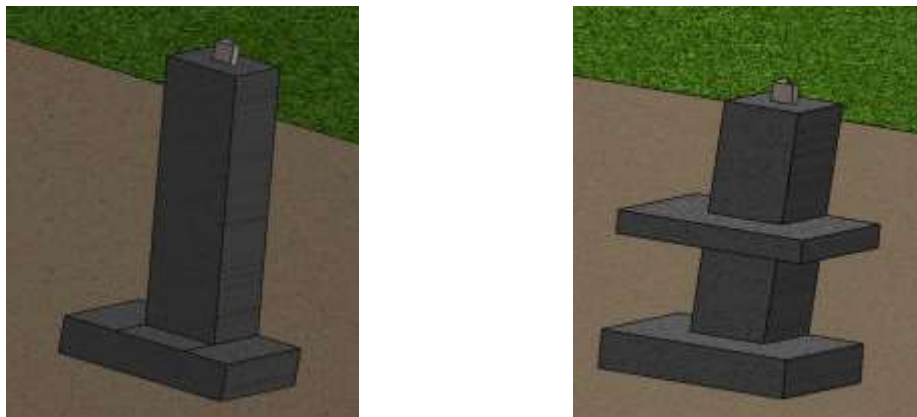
Cimentación de zapata simple (izq), cimentación de zapata doble (der)
